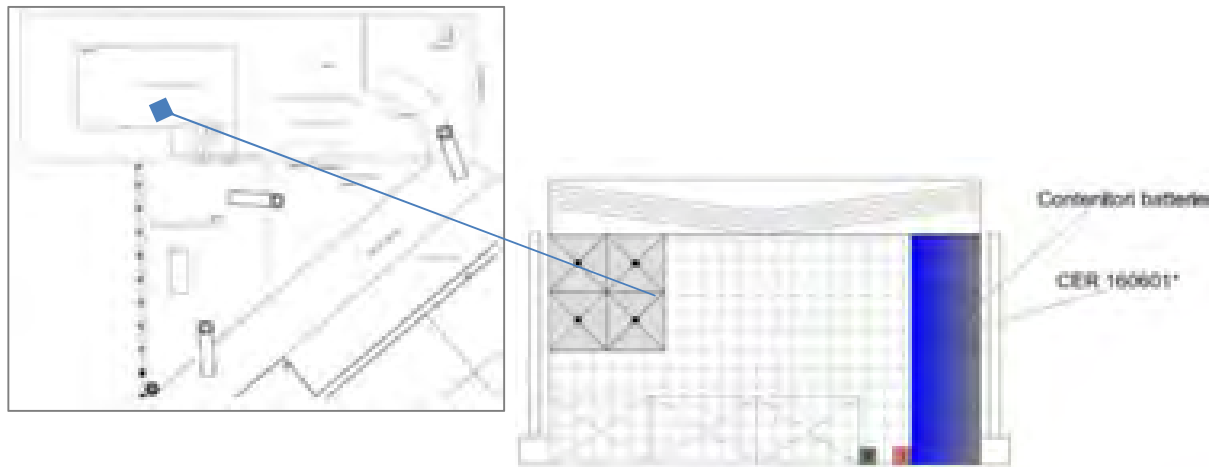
Estratto Planimetria Generale – Stoccaggio Rifiuti Pericolosi
